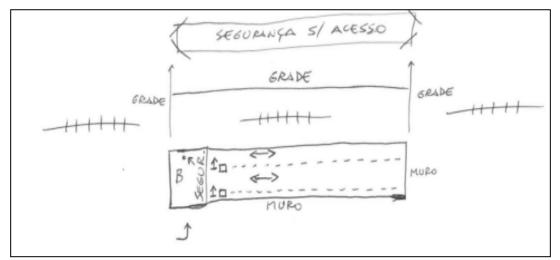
Croqui da estação Ajuda paralela à Avenida 1 – opção 1 (elaboração do autor)
